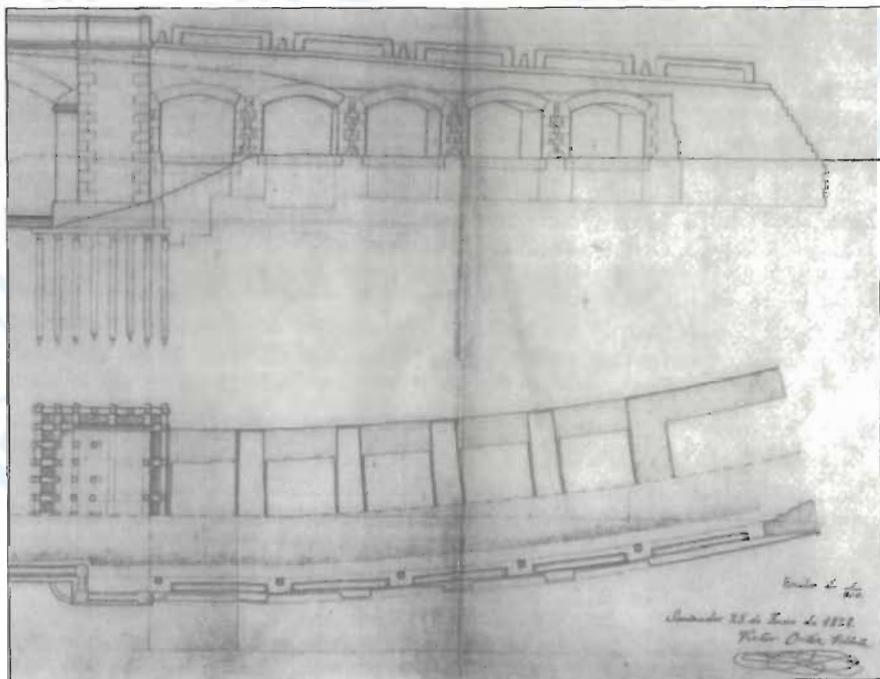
proyecto de alcantarillas para el puente de Ampuero-Marrón.
